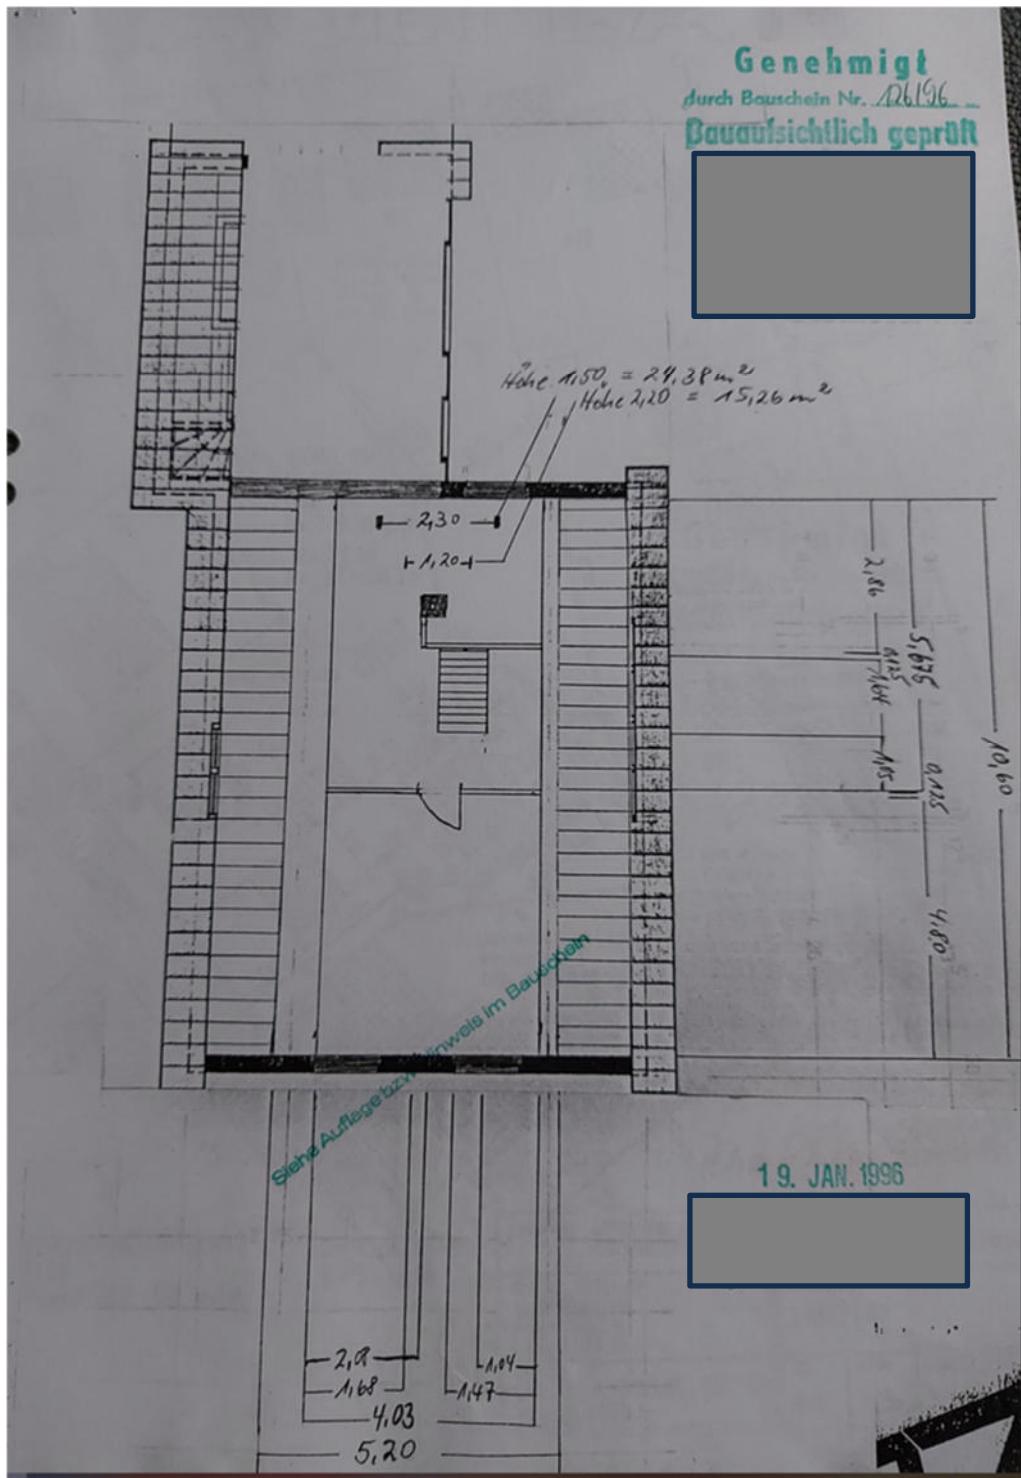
Dachgeschoss / Plan aus der Bauakte Abweichungen sind möglich
